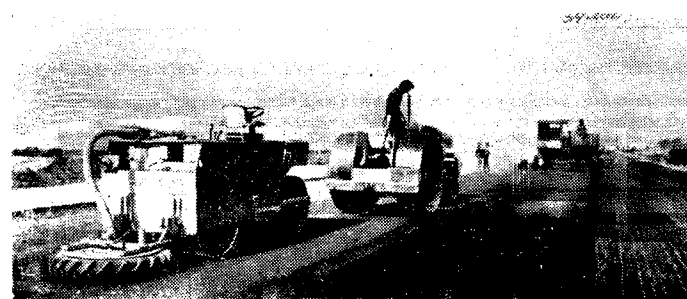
Промышленный образец двухвальцового катка весом 4 т с пневмовакuumным балластным устройством и двумя камерами проходит испытания
